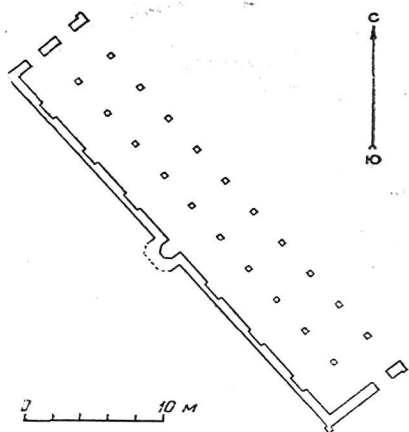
Гузар. Намазгах рубежа XIX—XX вв. План
